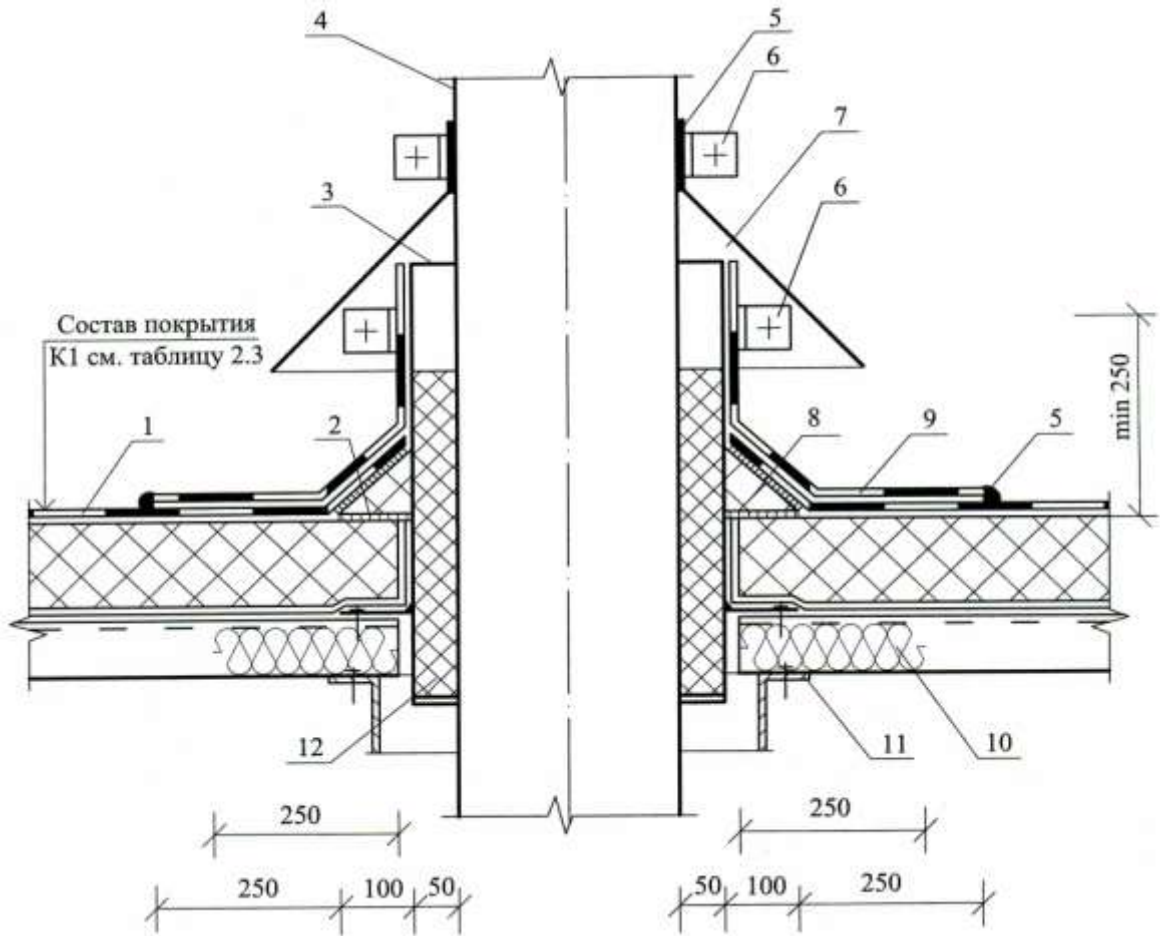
Примыкание кровли с несущим профилированным настилом к трубе
